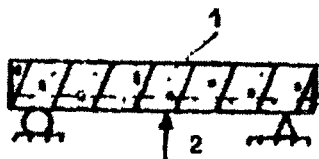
Схема испытания железобетонной конструкции вибрационным методом:
